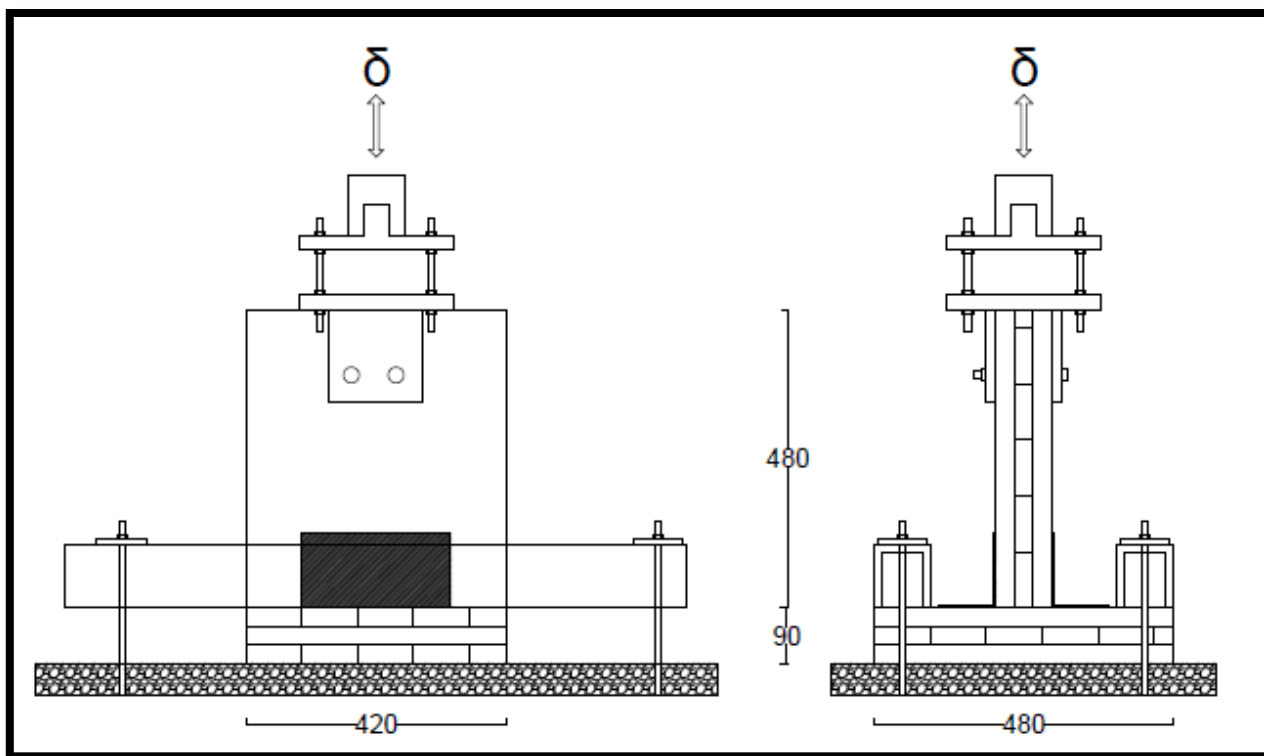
Configuración de prueba para conexión muro-losa del angle bracket cargado en tensión.
